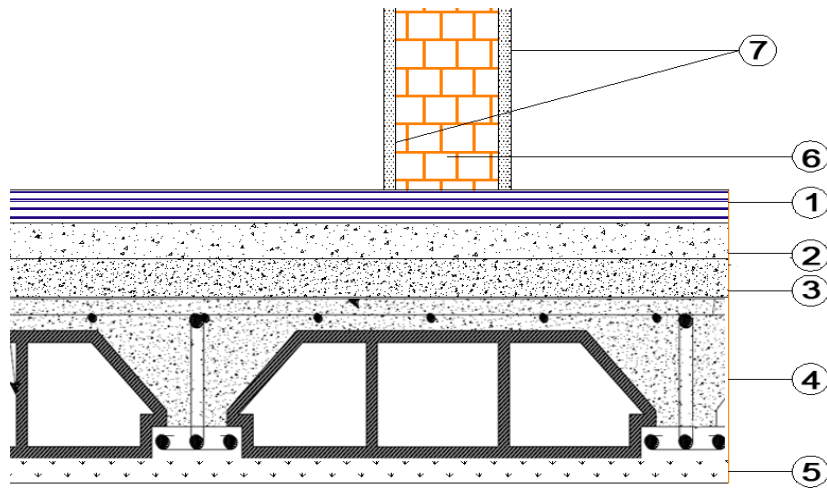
Coupe verticale d'un plancher d'étage courant.
